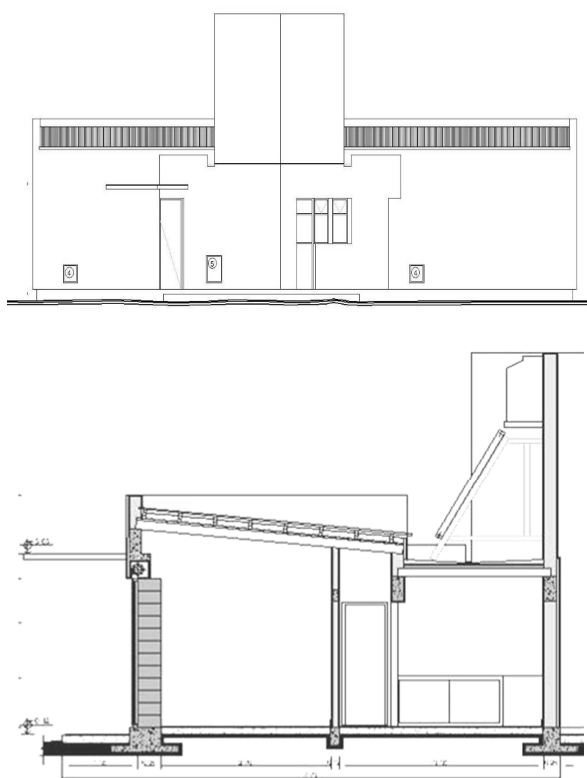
Fachada sur y corte transversal de la vivienda de tres dormitorios
